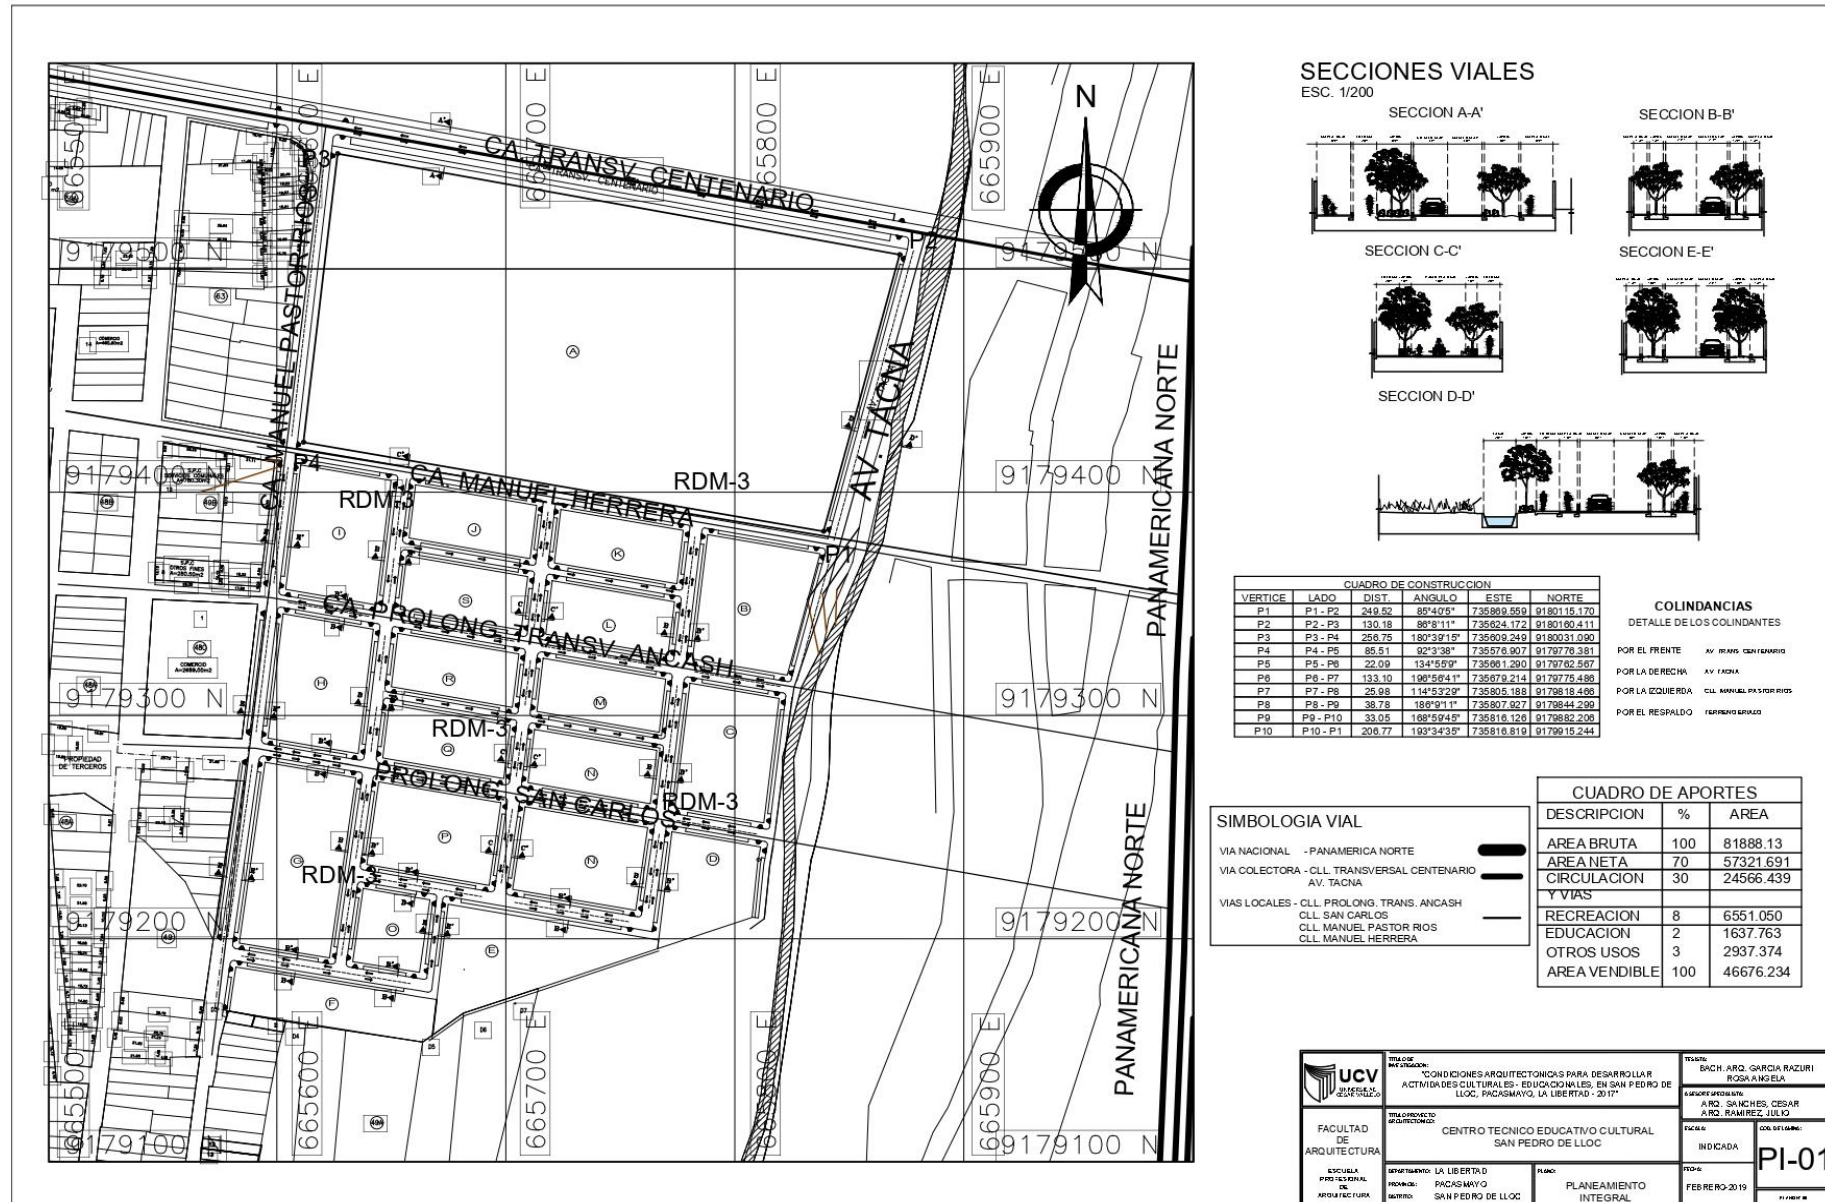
Plano de Planeamiento Integral - Plano N° 06 - Lamina N°: P.I. - 01
